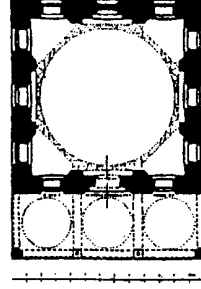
مسقط أفقى لتربة حاجى سلطان
